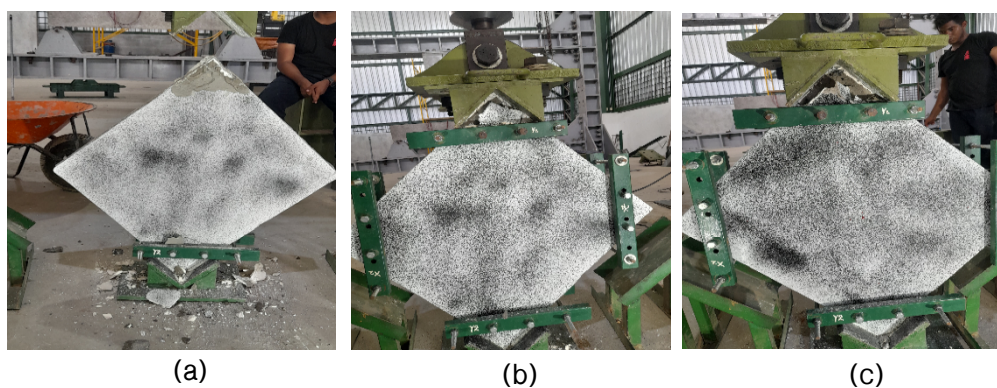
Muretes con bloques de hormigón: (a) MB-001; (b) MB-002; (c) MB-
